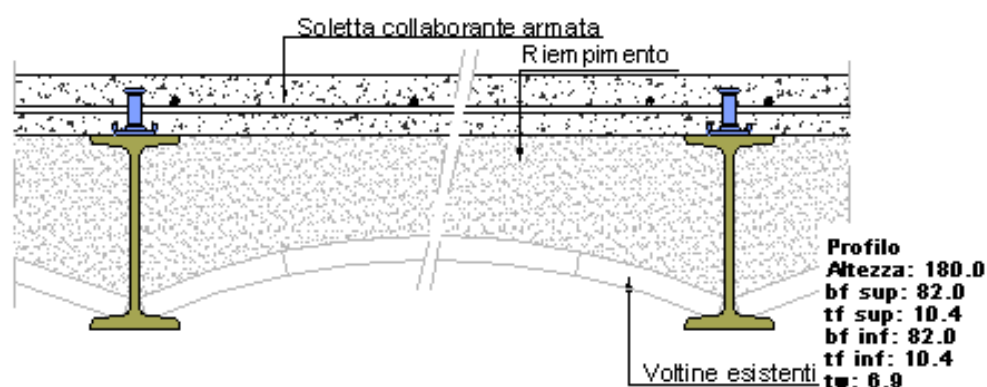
Sezione solaio volterrane con soletta collaborante.
